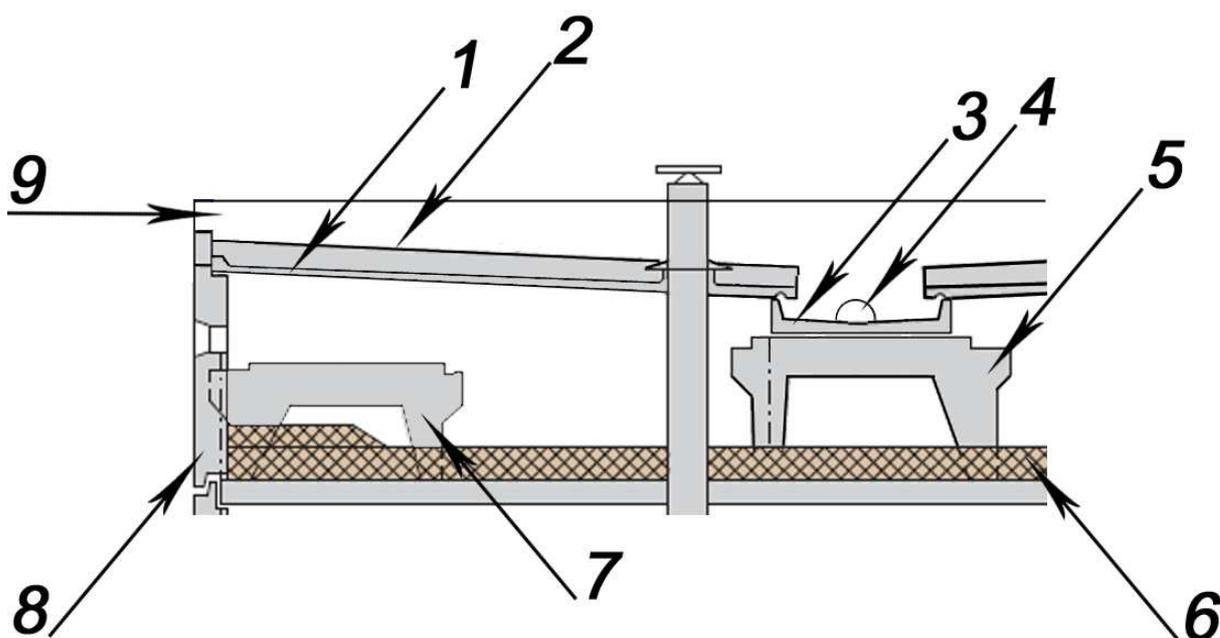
Конструктивная схема сборной железобетонной безрулонной крыши с внутренним водоотводом и холодным чердаком.
